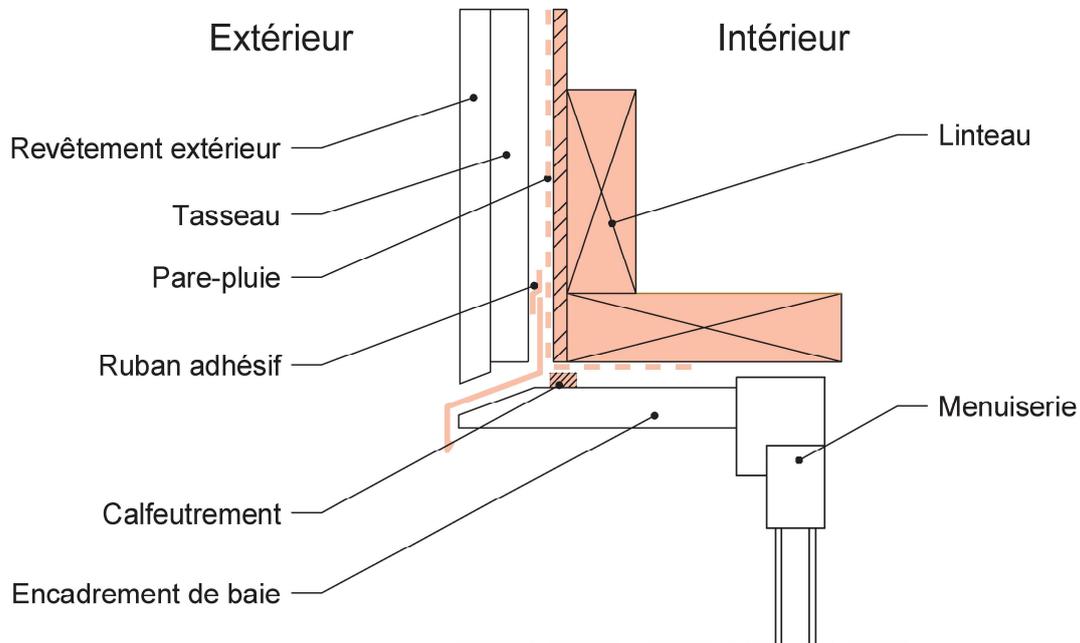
Pontage pare-pluie / larmier au ruban adhésif
